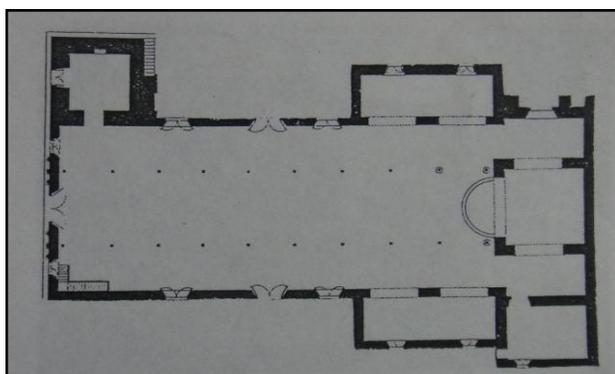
Planta Arquitectónica de la Iglesia de Sutiaba.
